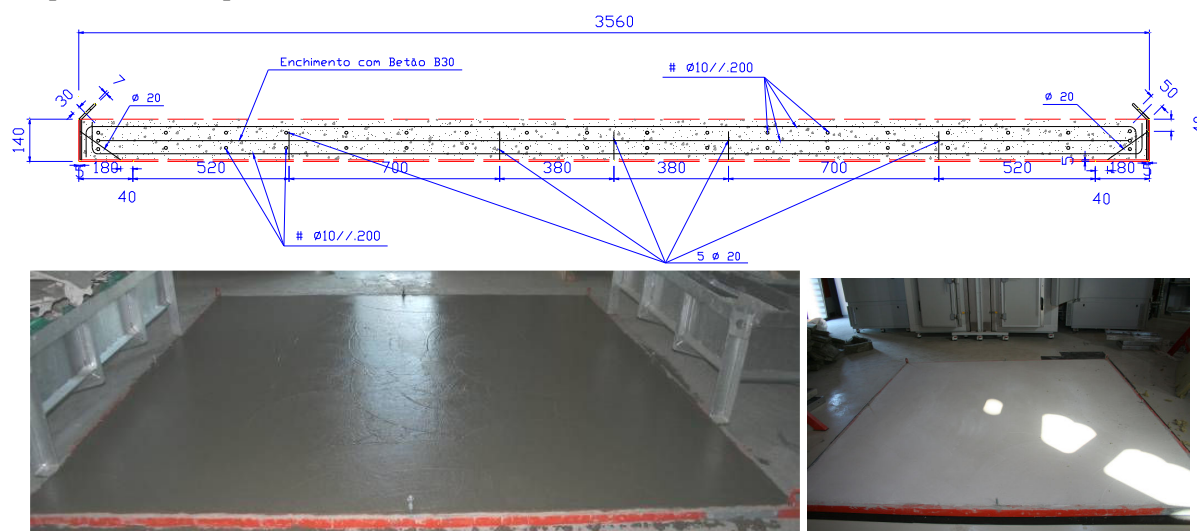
Constituintes do provete: a) Laje de betão armado b) lajeta de betão armado.
